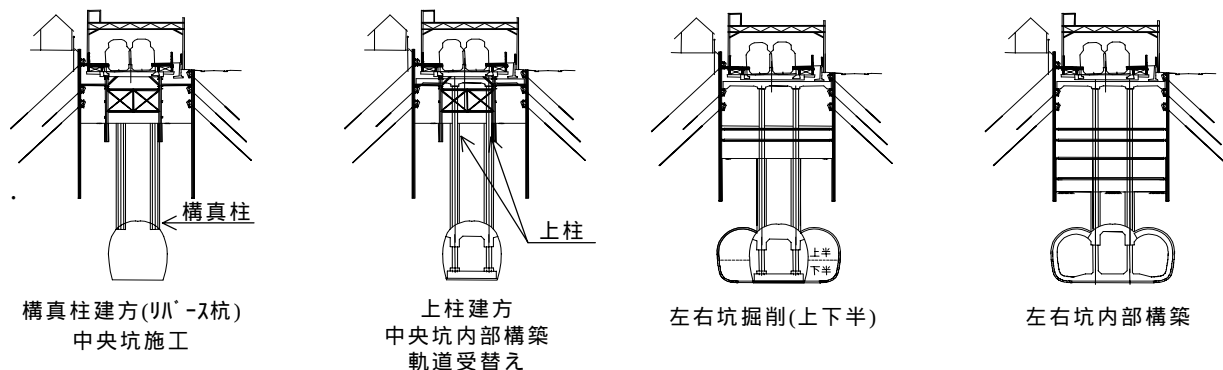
キノコ断面(開削併用区間)の施工ステップ
